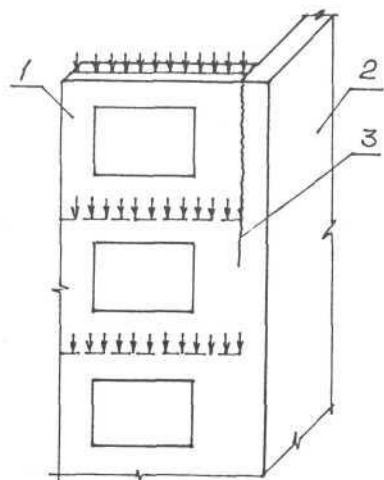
(1 – несущая стена, 2 – самонесущая стена, 3 – трещина)
